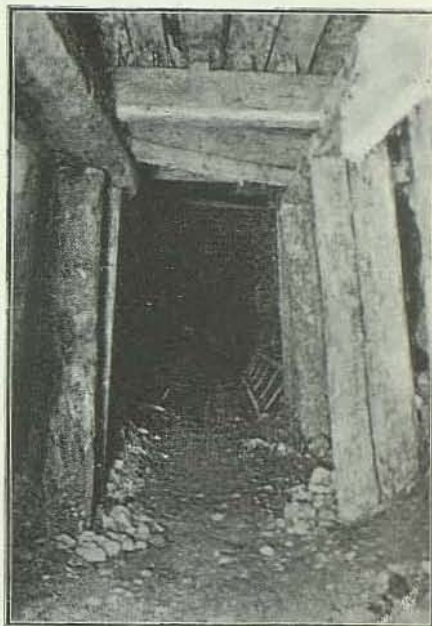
Galería de avance de los trabajos subterráneos del Metropolitano de París
